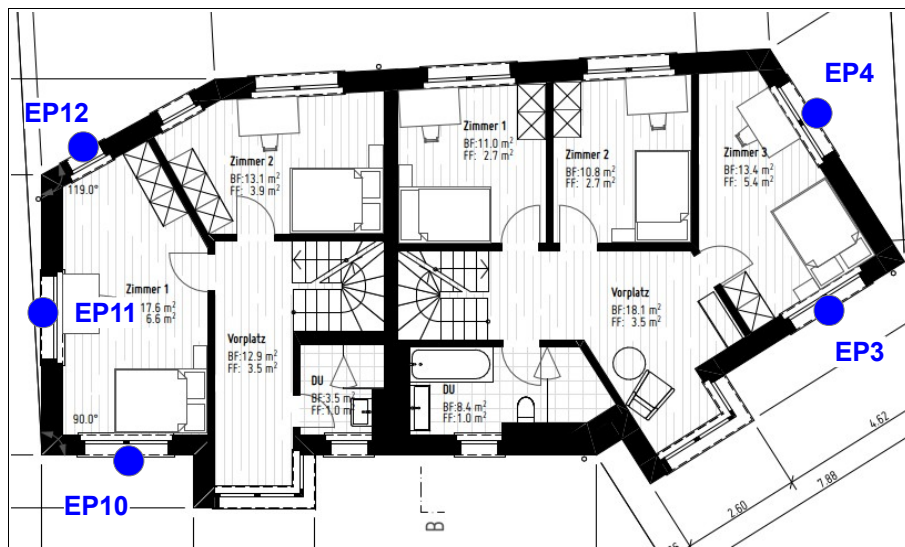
Grundriss 1.OG, ohne Mst.; Quelle: Architekt
